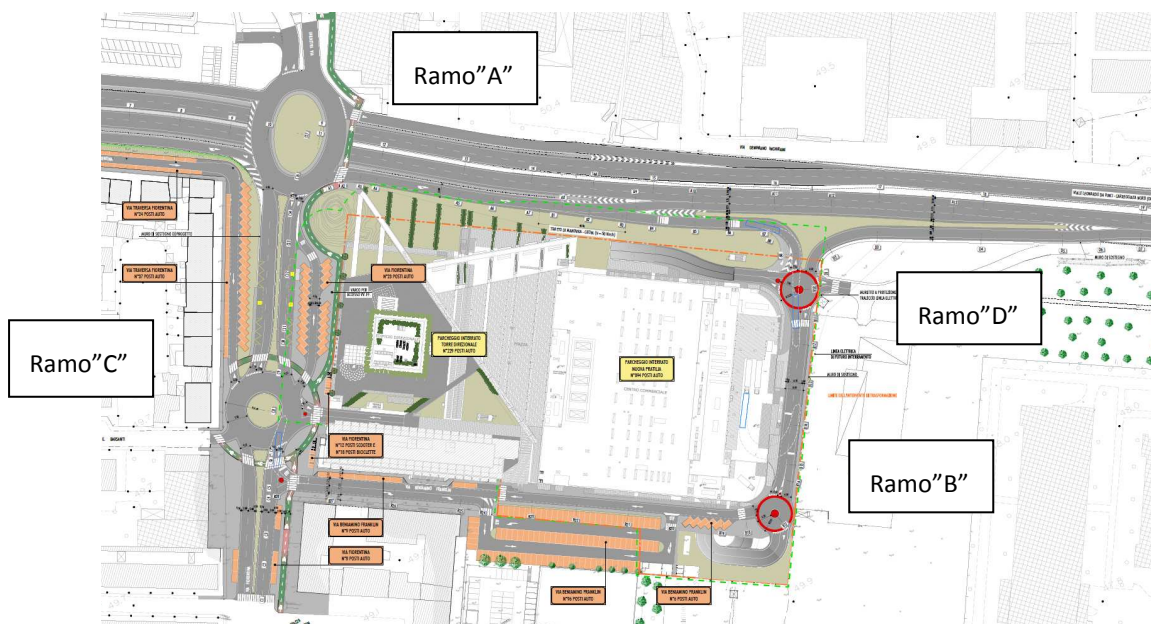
STRALCIO PLANIMETRICO
